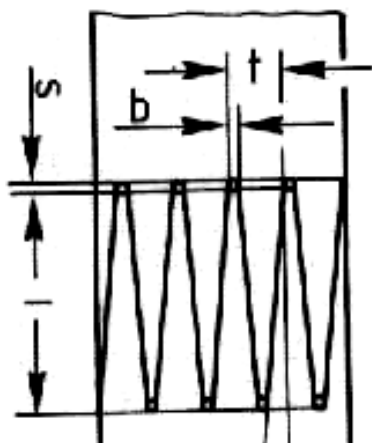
Зубчатое клеевое соединение (l - длина шипа, t - шаг соединения, b - затупление шипа, s - зазор в стыке).
